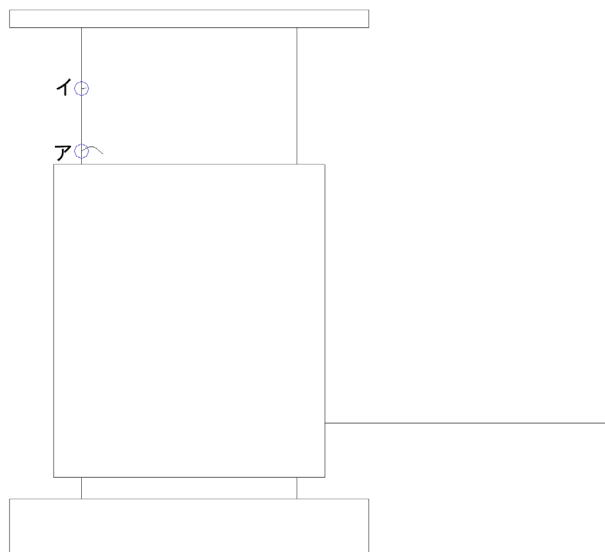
柱ひび割れ幅測定位置(試験体 A-2 正載荷)
